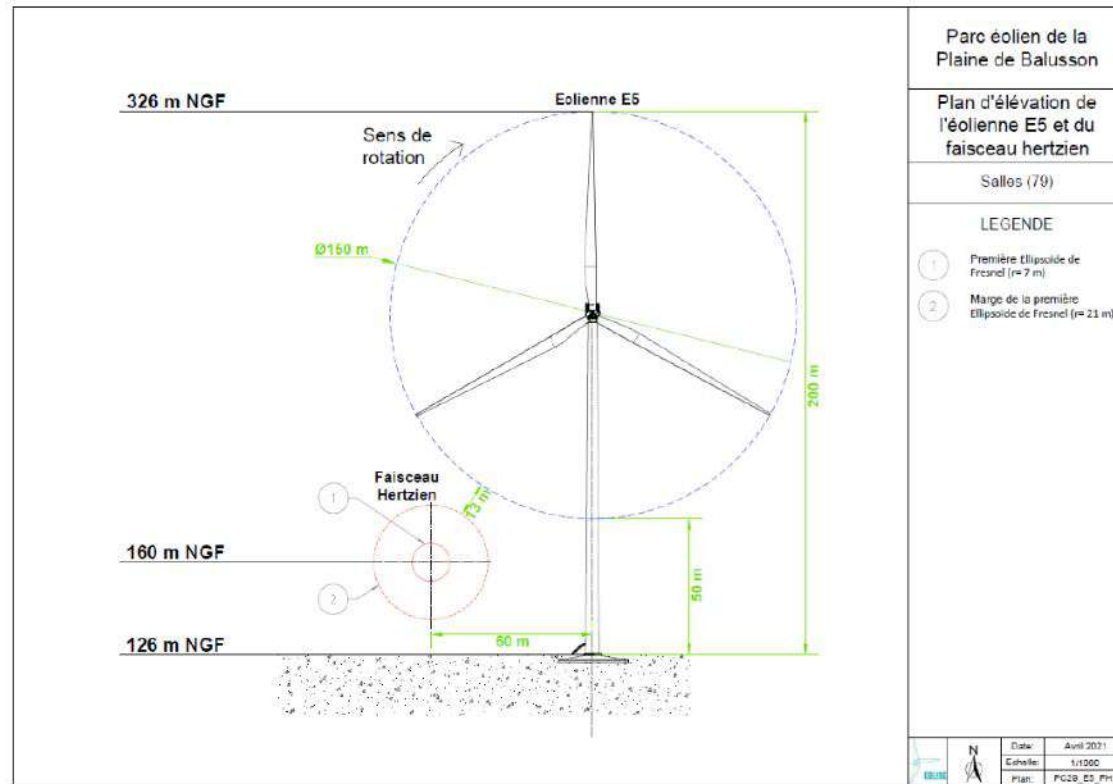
Plan d'élévation de l'éolienne E5 et du faisceau hertzien de Bouygues
